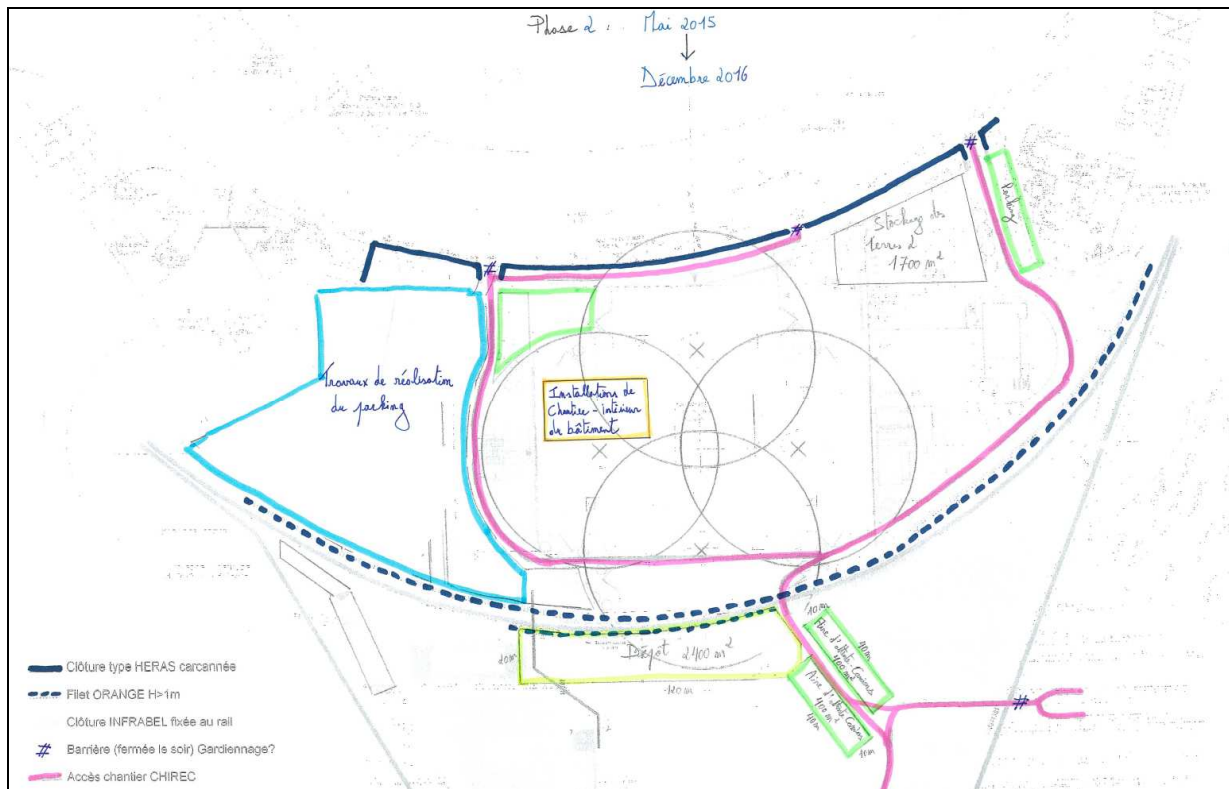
Plan provisoire d'installation de chantier de l'hôpital - phase 2 (Source : ASSAR)
